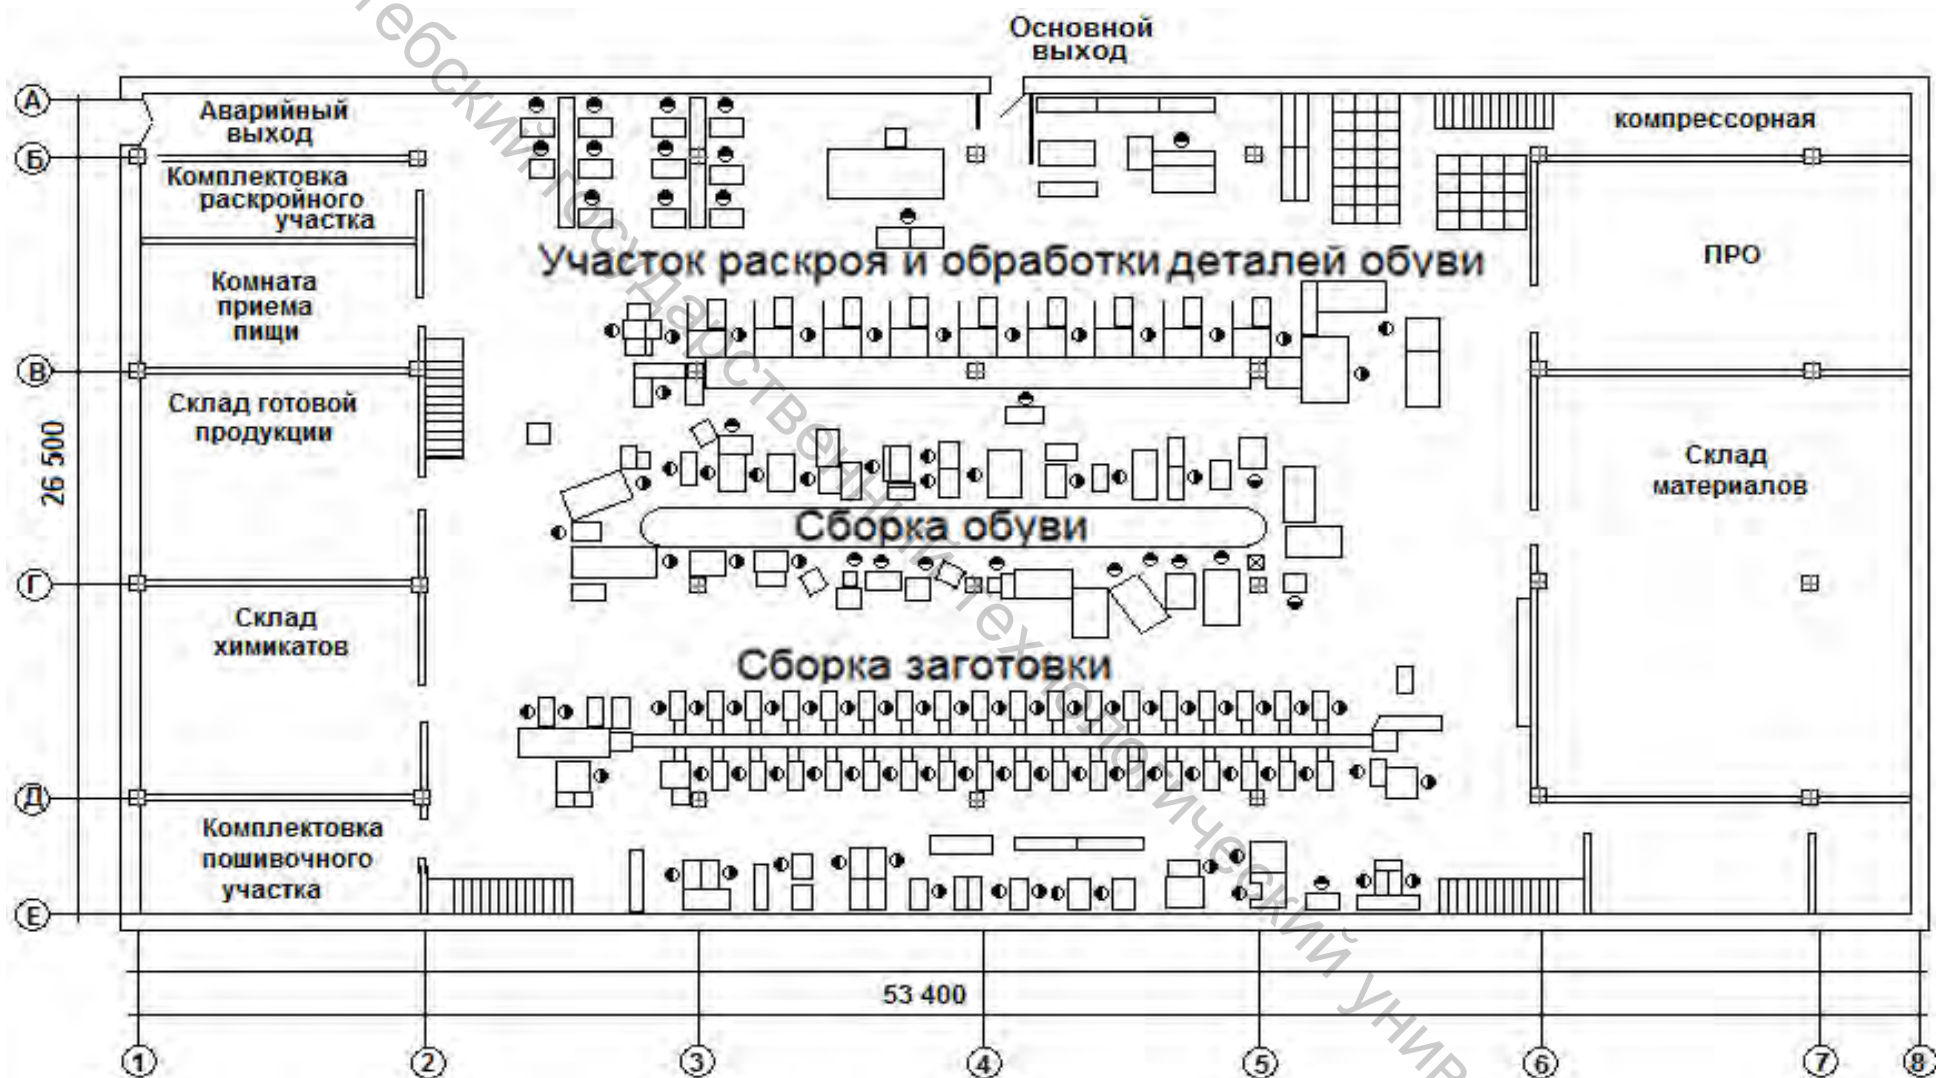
Компоновка цехов предприятия по изготовлению обуви клеевого метода крепления
